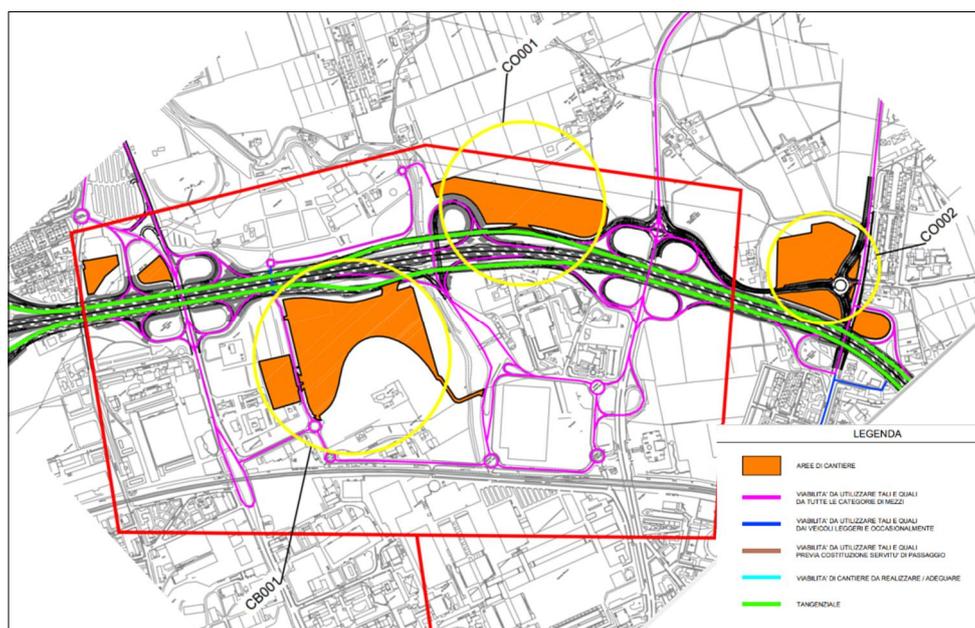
Sistema di interconnessione aree cantiere CB01 CO01 CO02 (stralcio da elaborato SIC5200)
